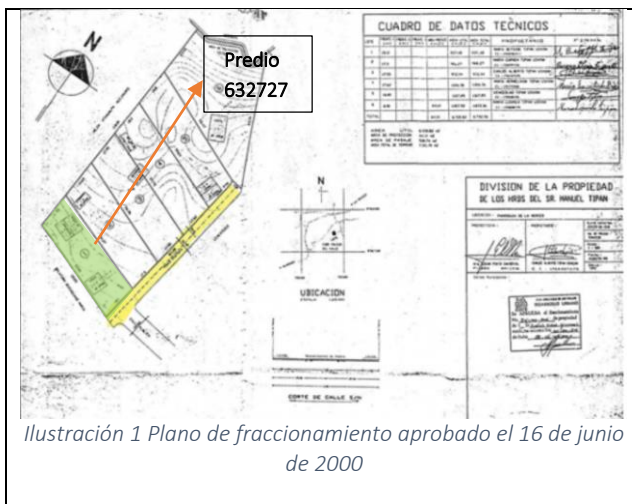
Plano de fraccionamiento aprobado el 16 de junio de 2000
